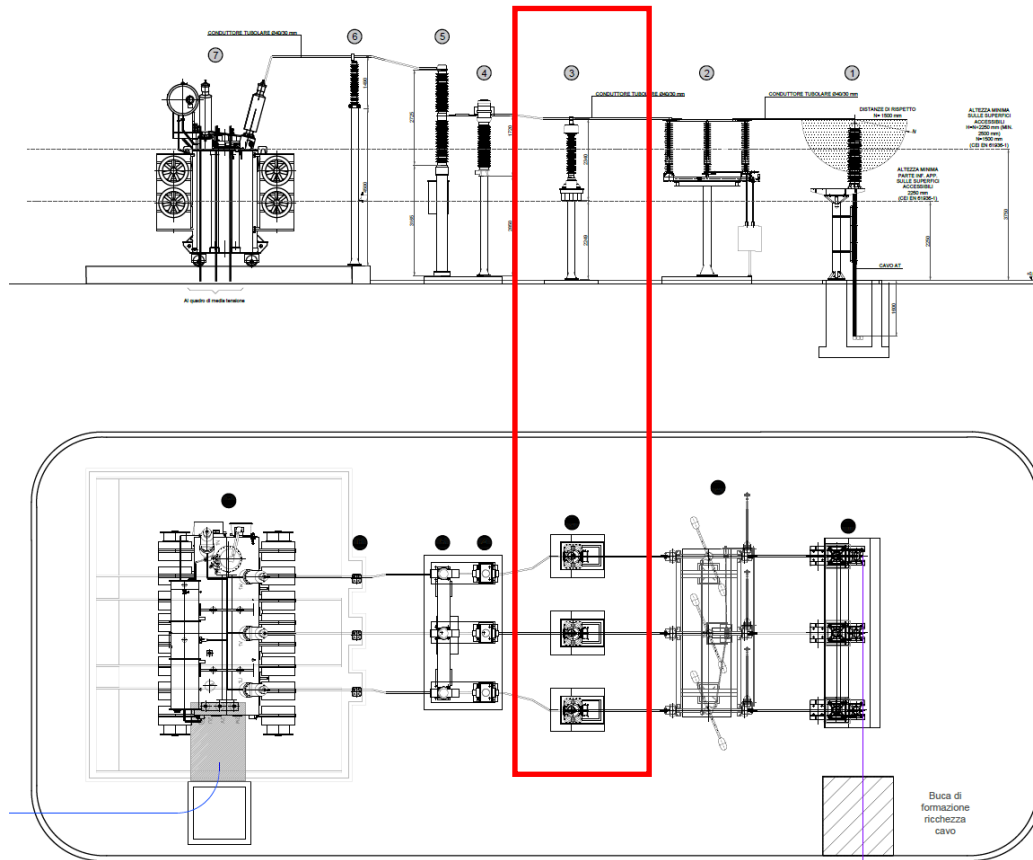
Prospetto e planimetria degli elementi della sottostazione utente.
